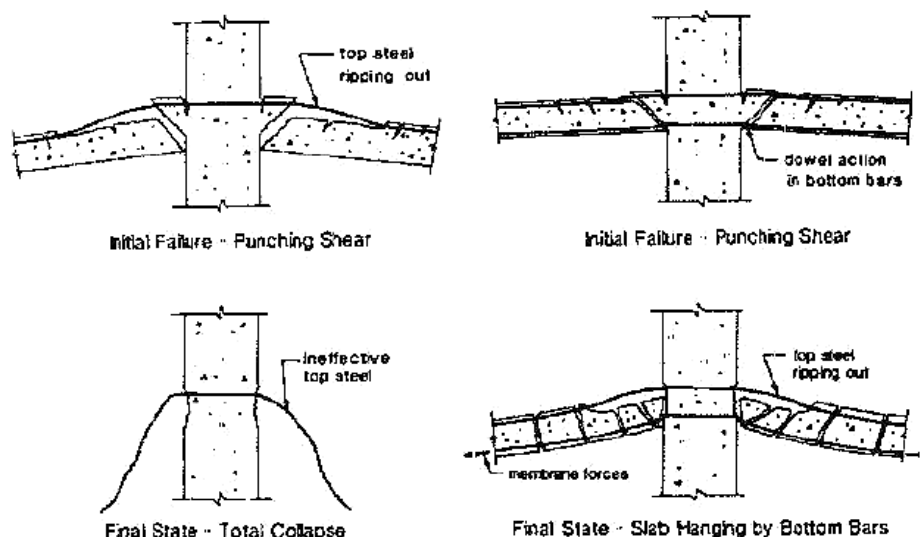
Efecto de las armaduras de cuelgue sin armaduras continuas inferiores (izquierda) y con armaduras continuas inferiores (derecha). (Maturana, 2013)
